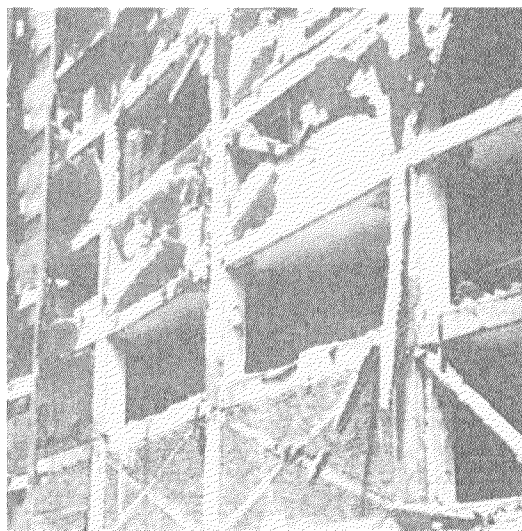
Daños secundarios en sistemas flexibles en: desprendimiento de paredes - Terremoto México 1985
